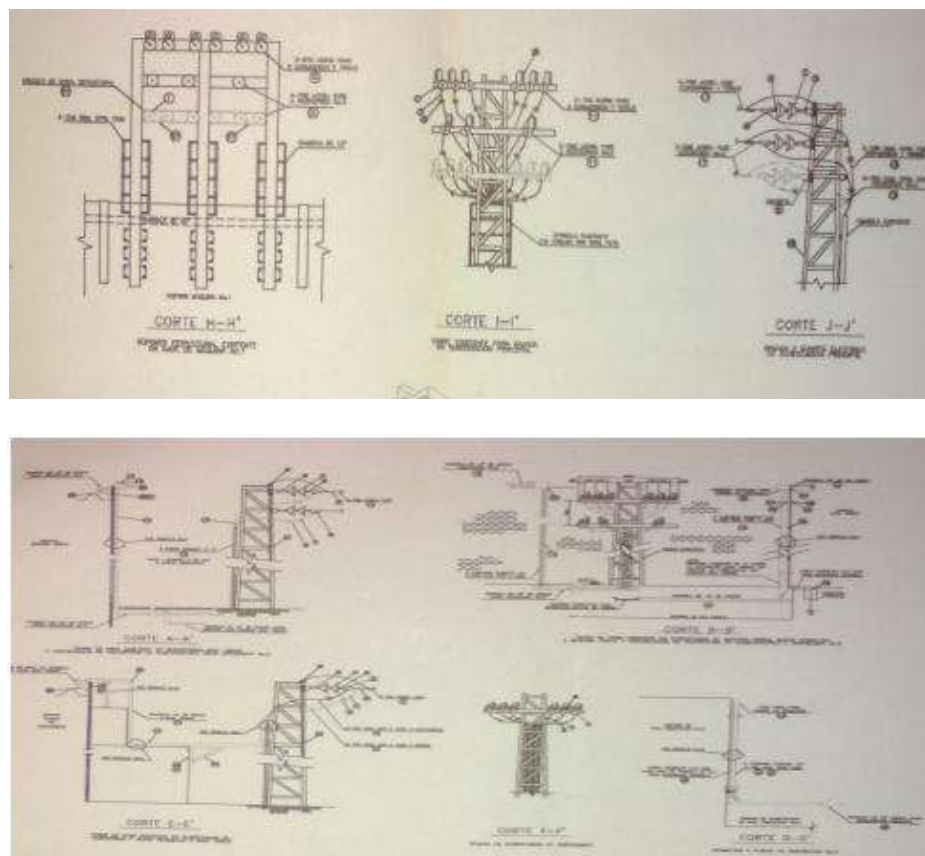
Detalles de soportería e instalación en torres de 2300 volts.
